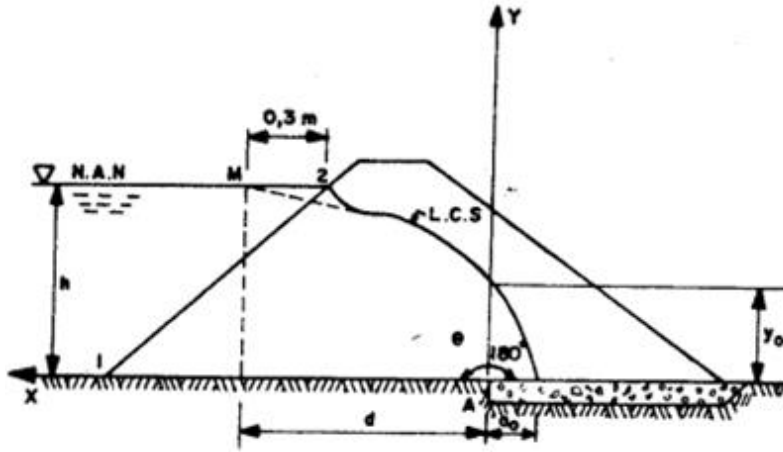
Sección de presa de tierra con colchón de drenaje
